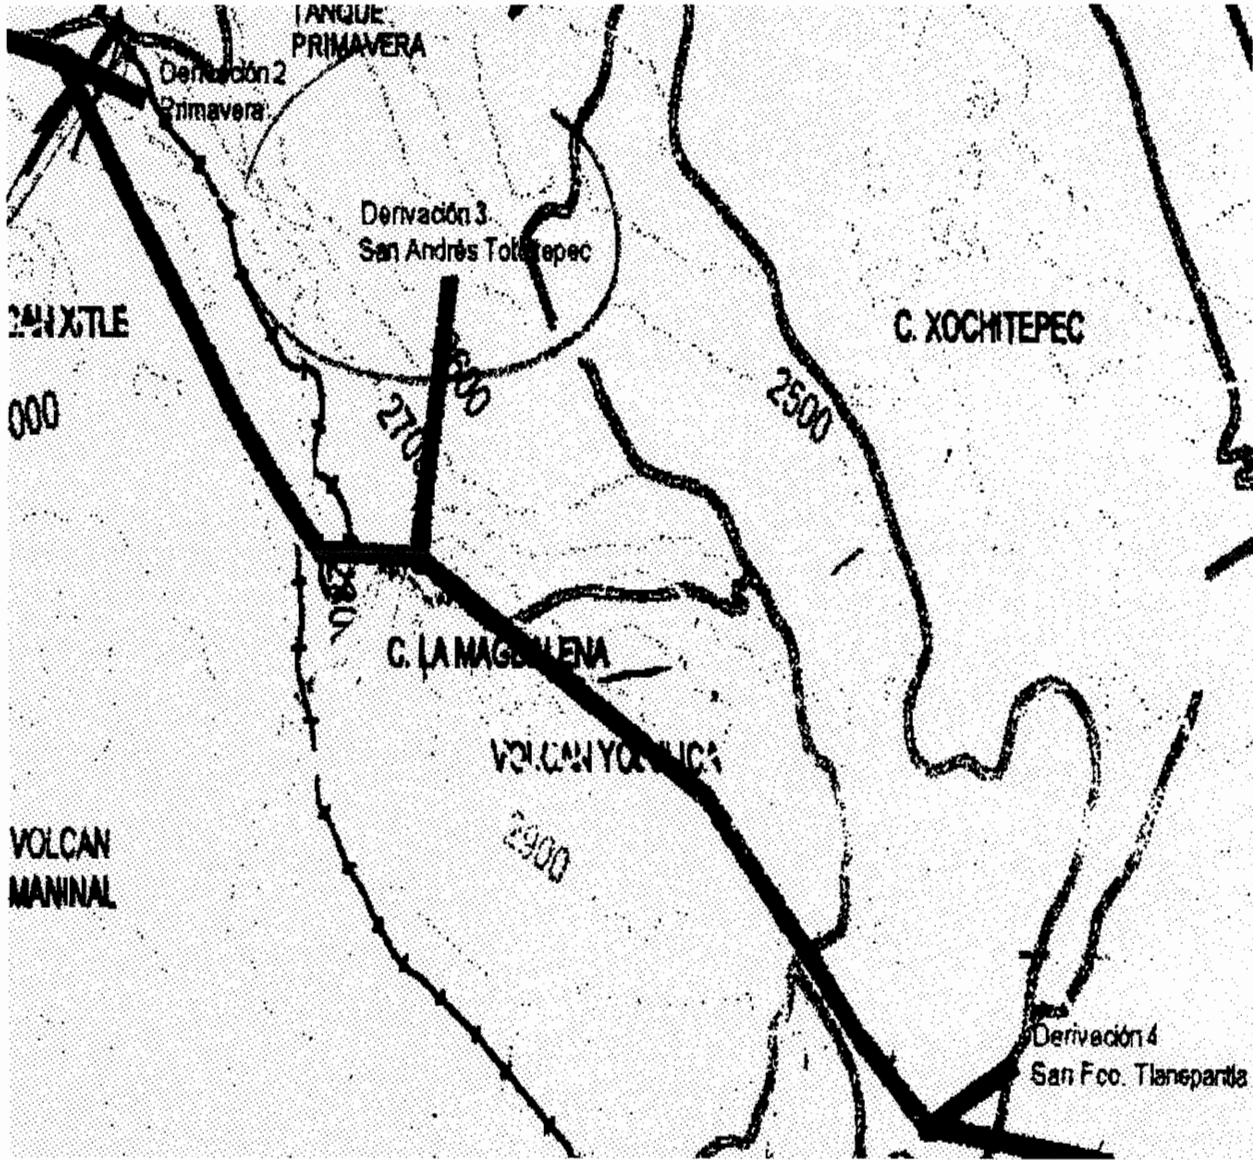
Planta y Perfil de la Tercera Etapa
